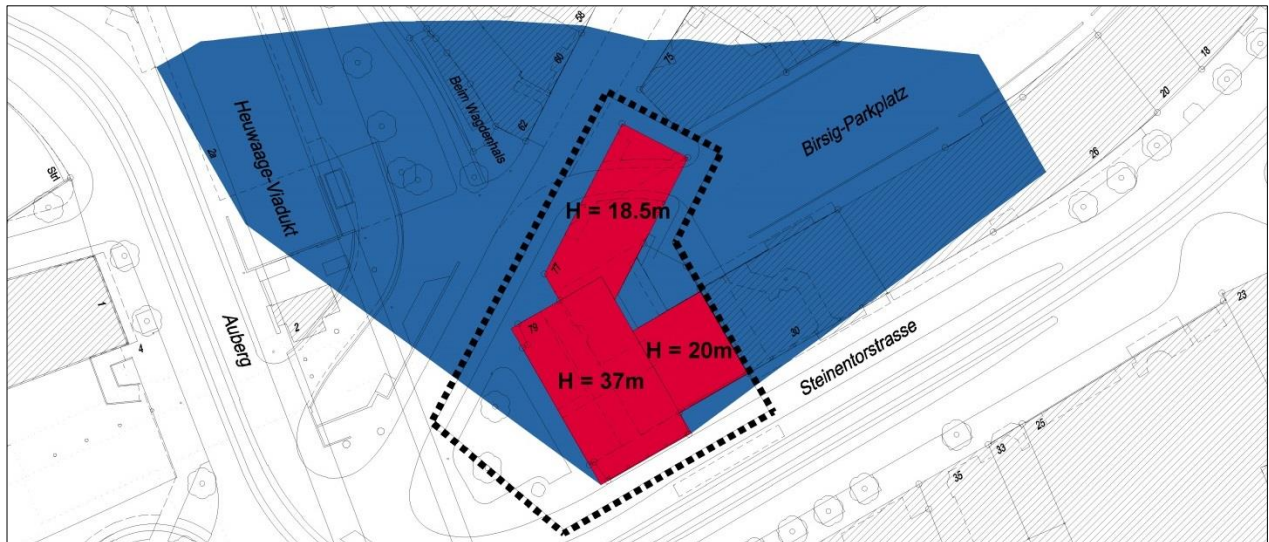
Zwei-Stunden-Schatten des bestehenden Hochhauses mit Sockel. Höhe = 37 m. (Kein Massstab, Plan genordet)
